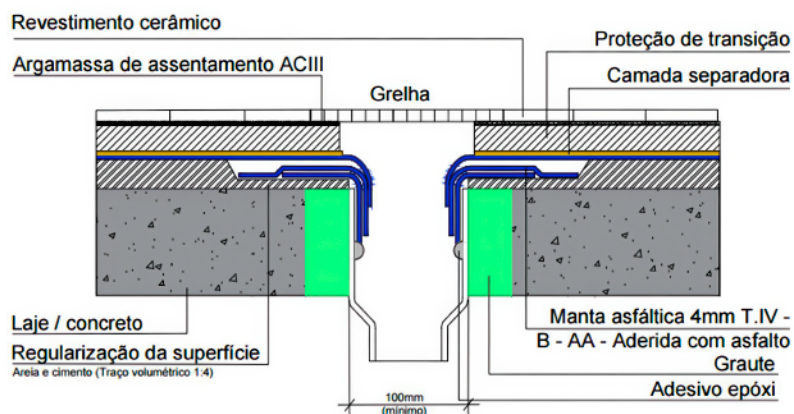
Fonte: Obra Seca Projeto e Consultoria em Impermeabilização
